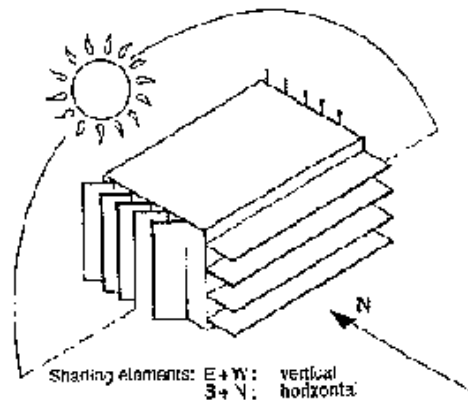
Dispositifs de protection solaire (source : Gut et Ackerknecht, 1993)
